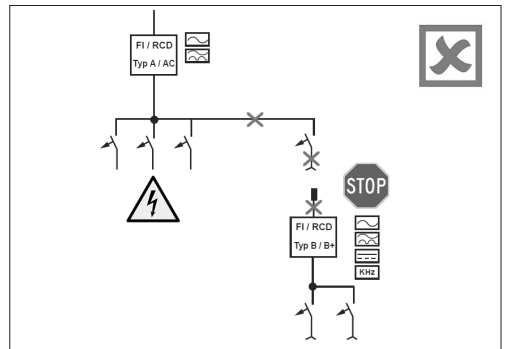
Fehlerhafte Elektroinstallation (Hausinstallation)
